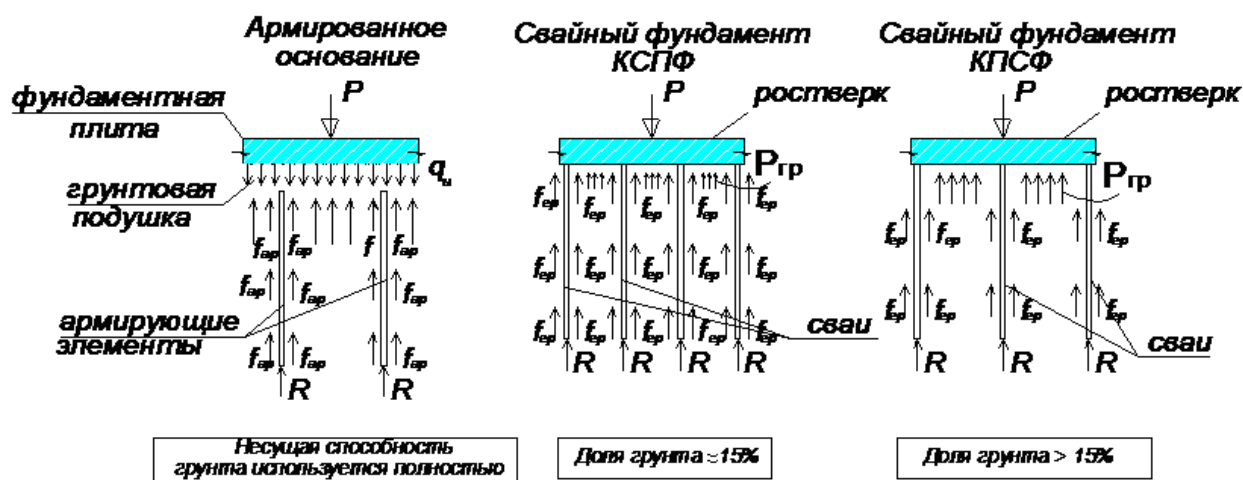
Схемы передачи нагрузки на армированное вертикальными элементами грунтовое основание, свайное основание типа КСПФ (комбинированный свайно-плитный фундамент) и КПСФ (комбинированный плитно-свайный фундамент)
